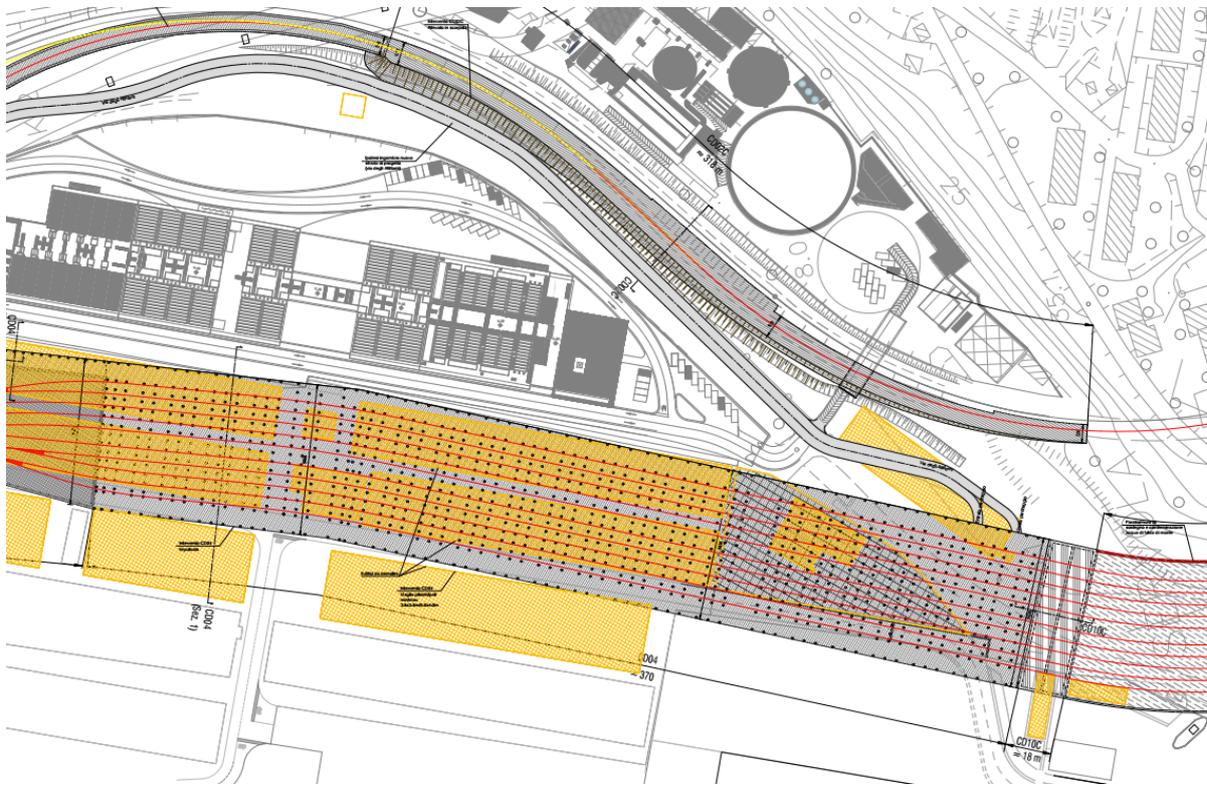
Zona Nord – Particolare della zona destinata a parcheggio (tratto CD04).
